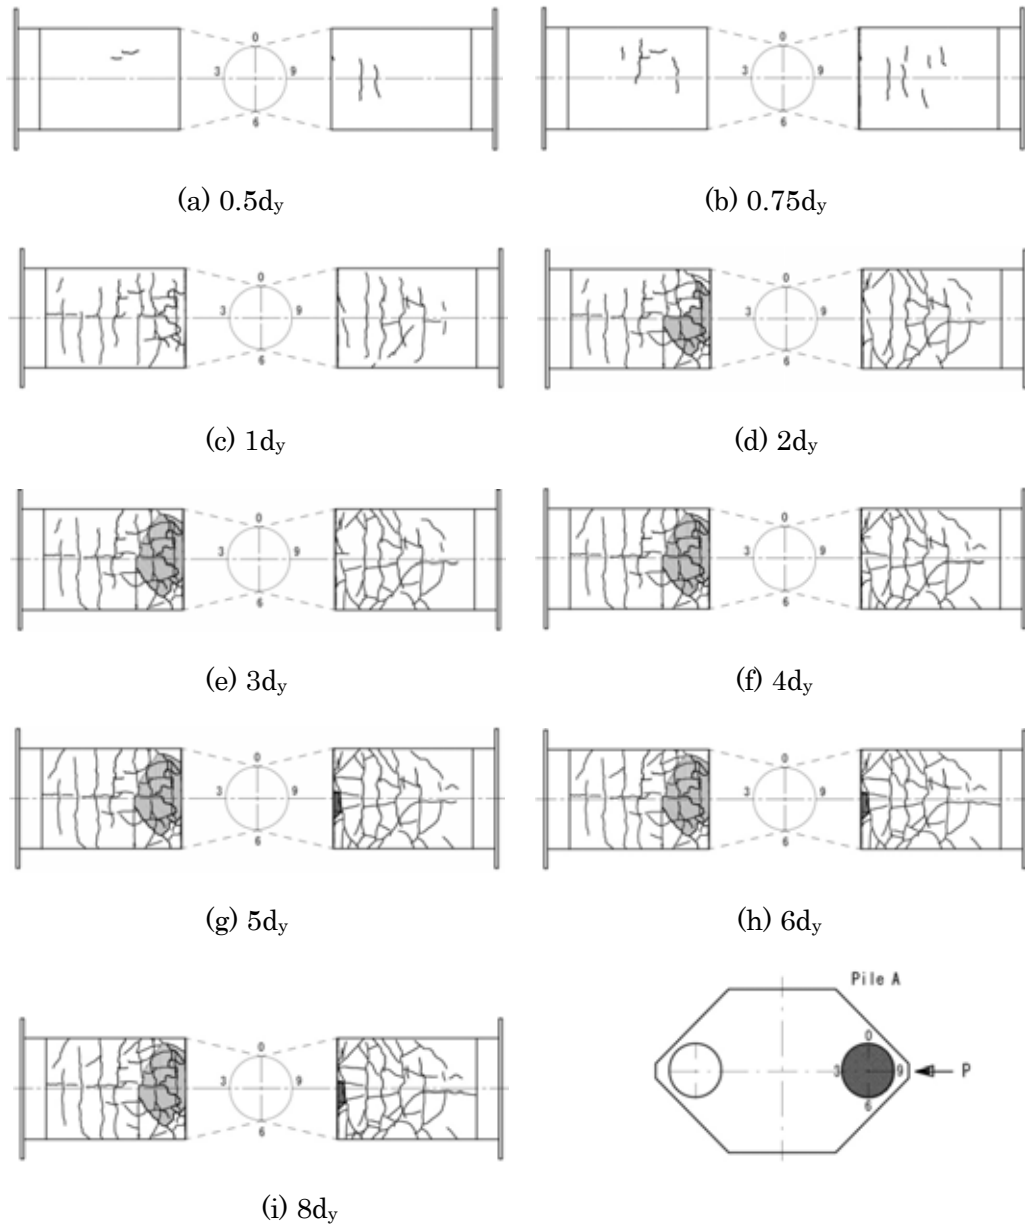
杭体のひび割れ進行状況図 (Case CPP-C-2, Pile A)
